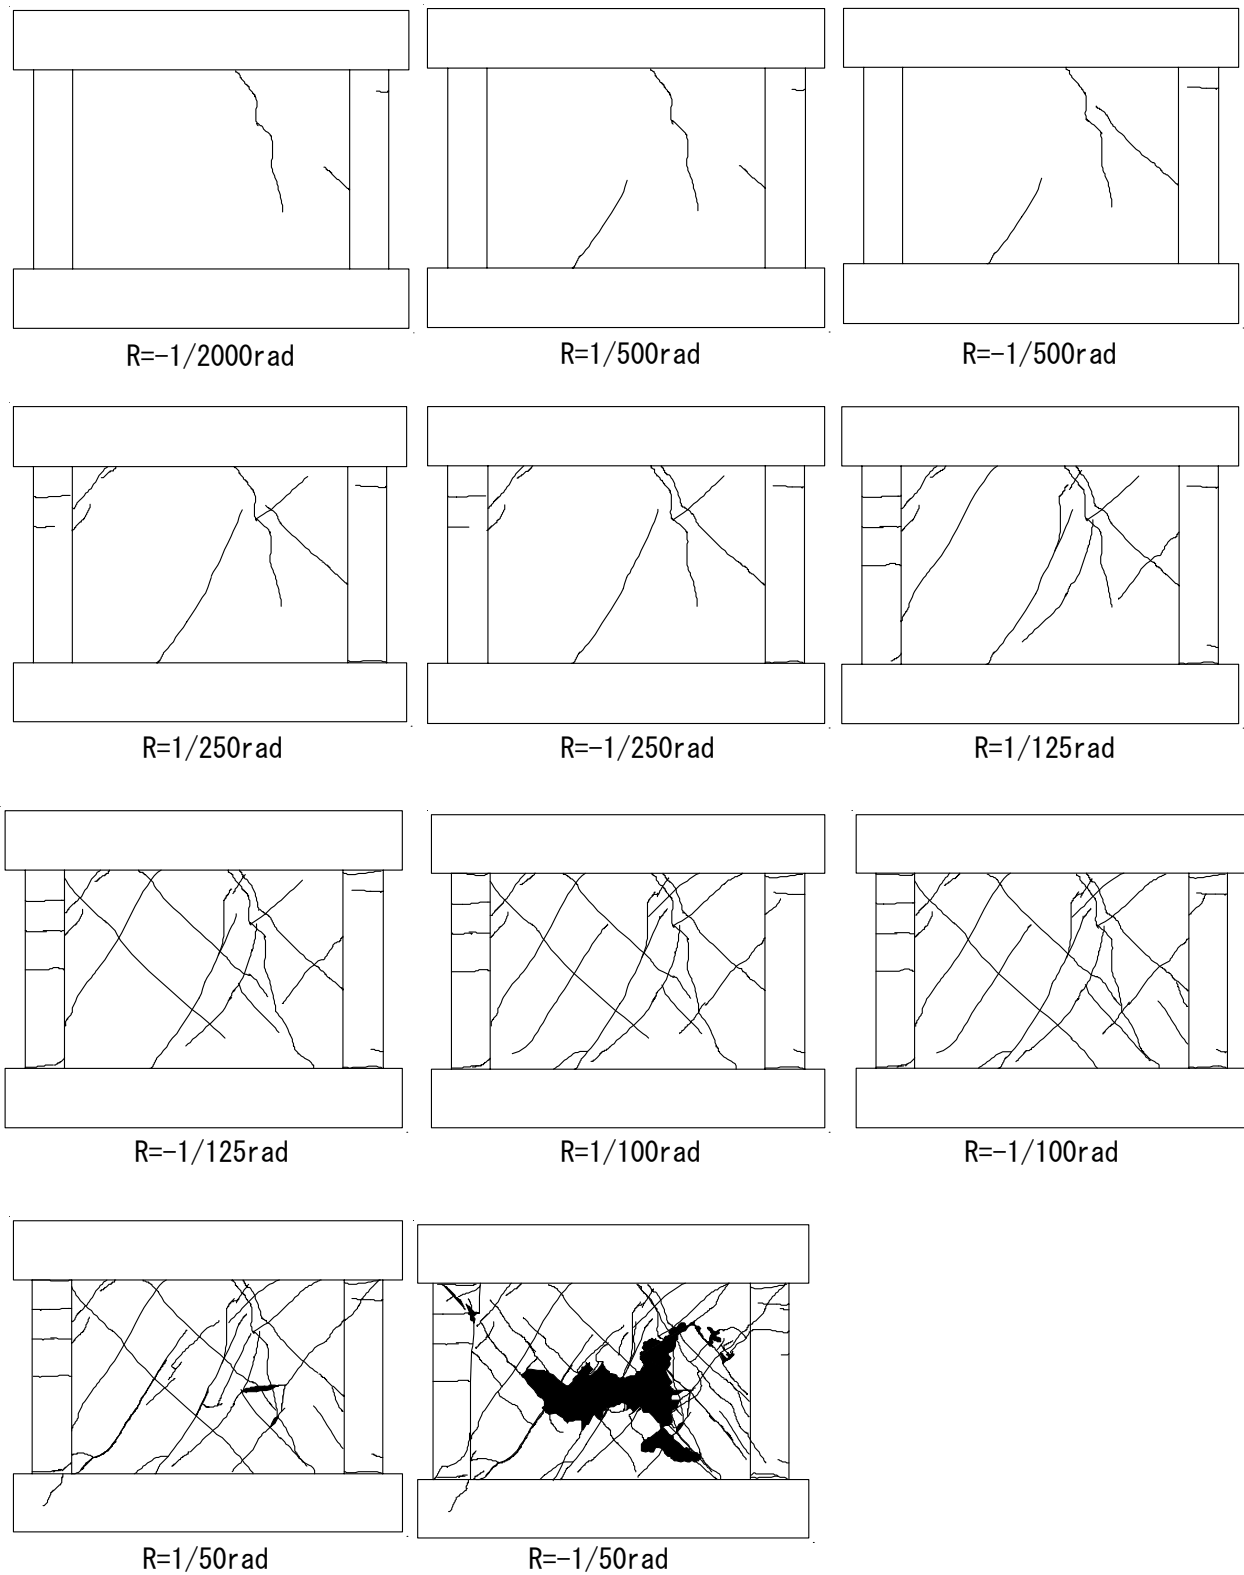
各変形角段階におけるひび割れ状況図 (Fc21W-2)
